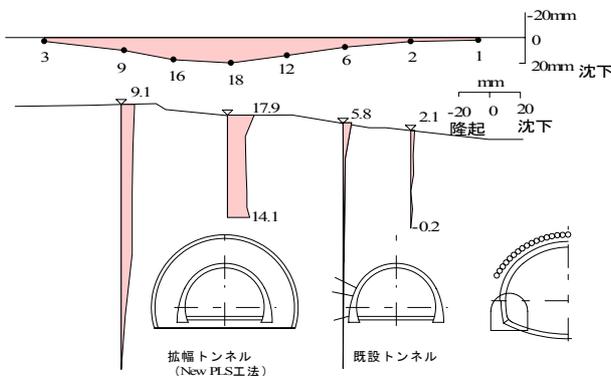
地表面沈下及び地中沈下横断面図(STA0+78)
